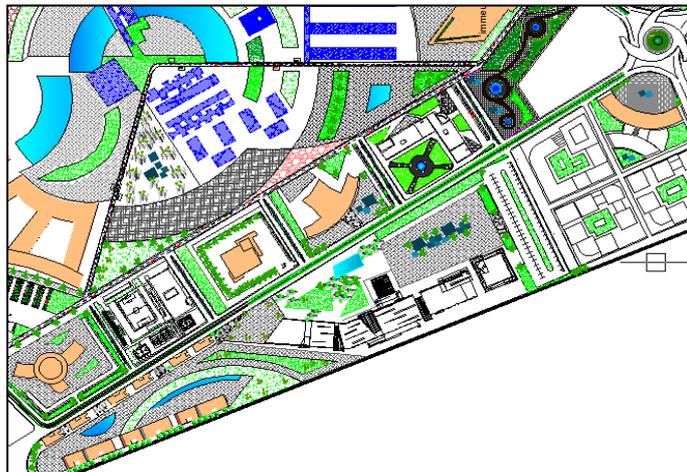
vue en plan de la voie de prolongement de mercure après intervention
